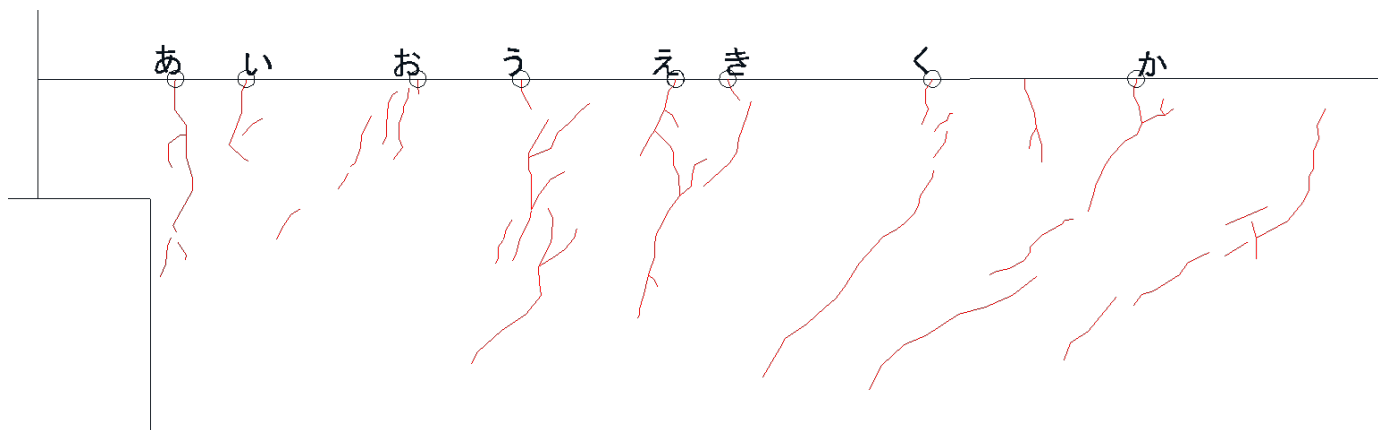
基礎梁ひび割れ幅測定位置 (試験体 D-2 負荷荷)
